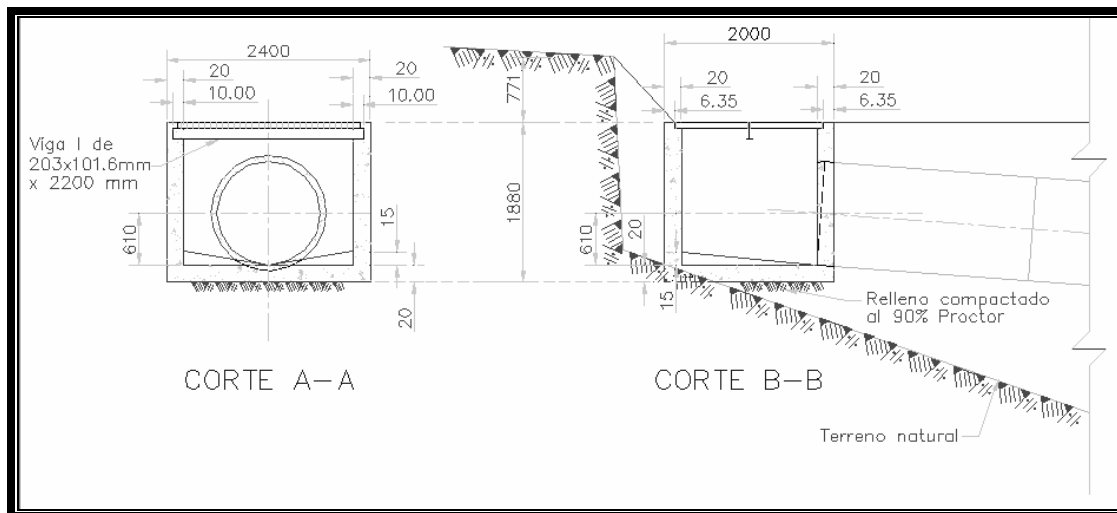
Vista del corte de la tubería y encajonamiento de esta.
